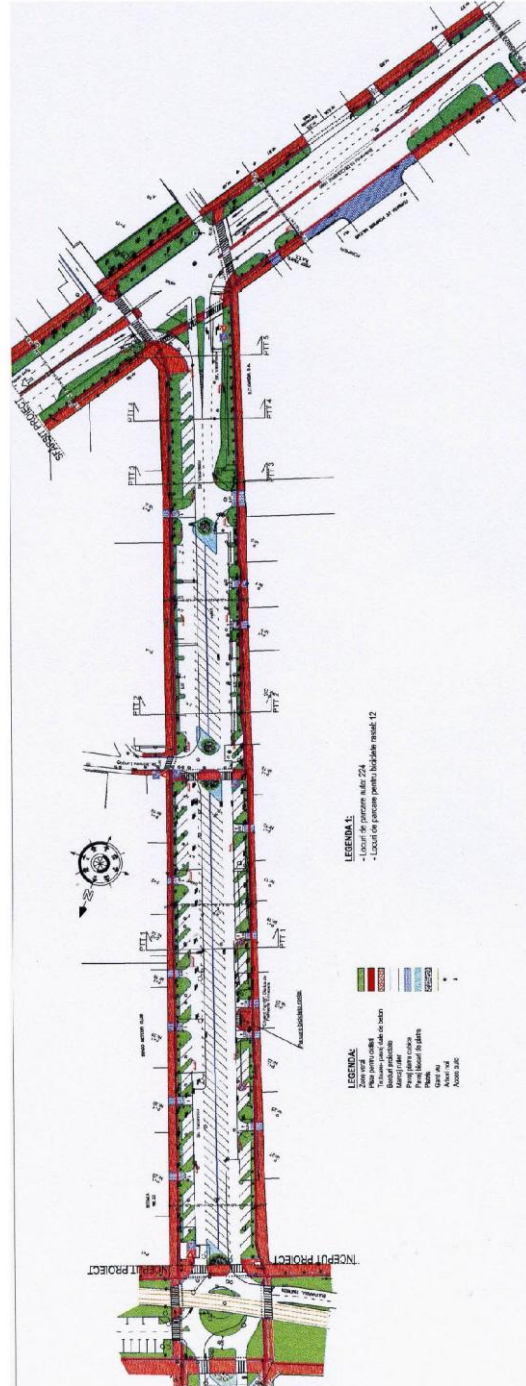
Plan de situație strada Iancu Văcărescu
